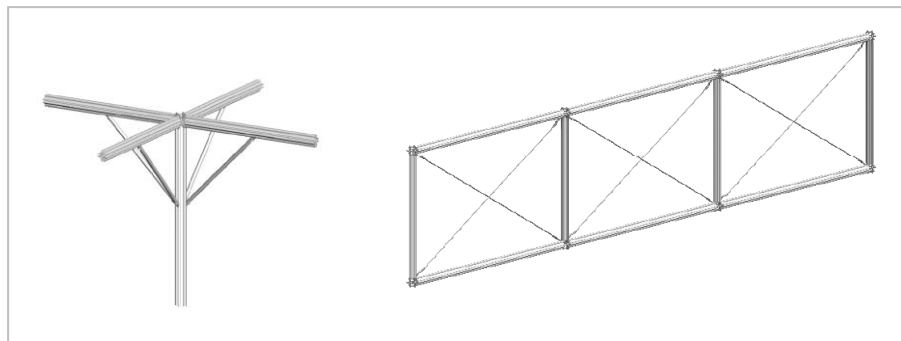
Elementos estruturais de apoio. Fonte: LEITNER, 2011.
